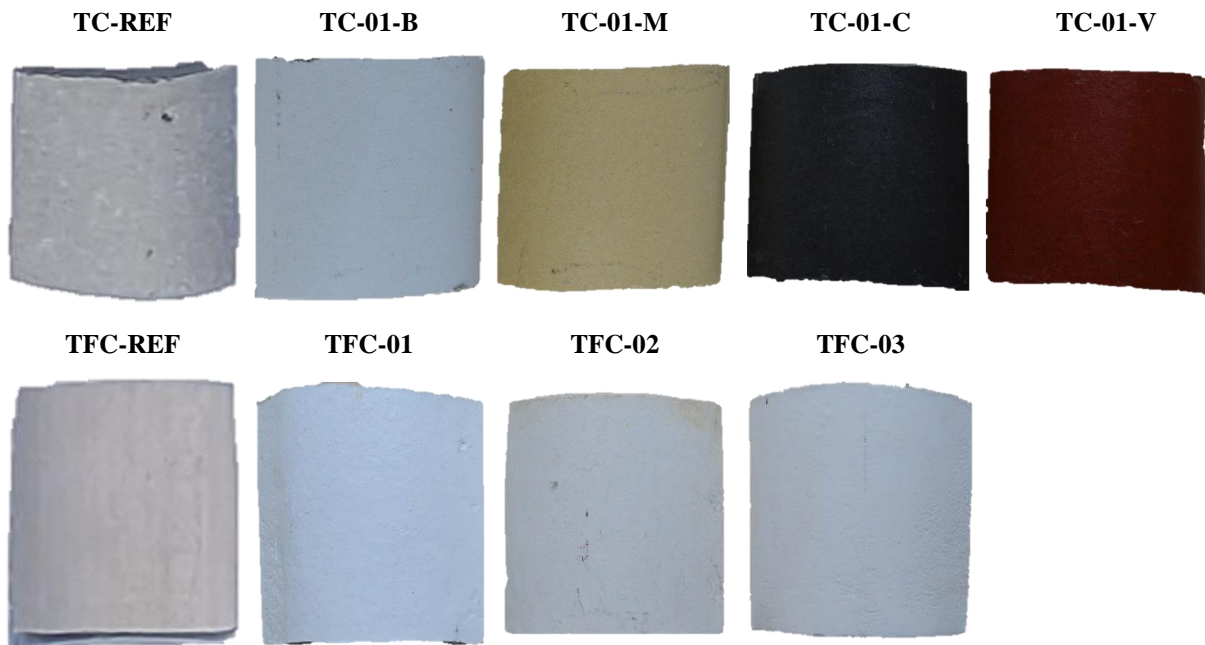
Amostras de tamanhos menores e médios das telhas de concreto e fibrocimento
